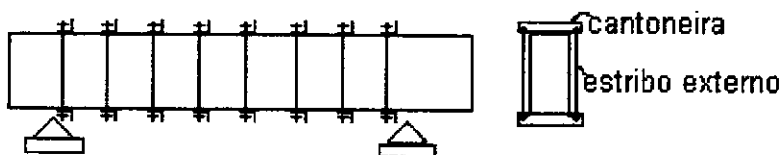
Viga reforçada ao cisalhamento com o uso de estribos externos pré-tracionados.
